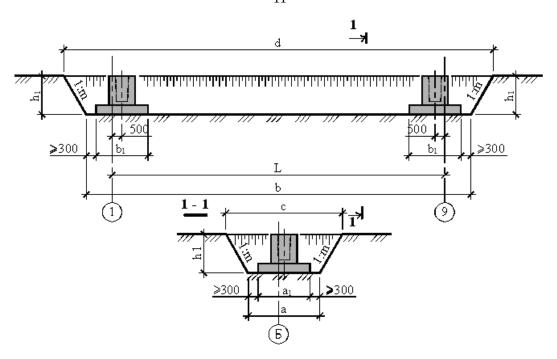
Схема расположения столбчатых фундаментов в прямоугольной траншее
